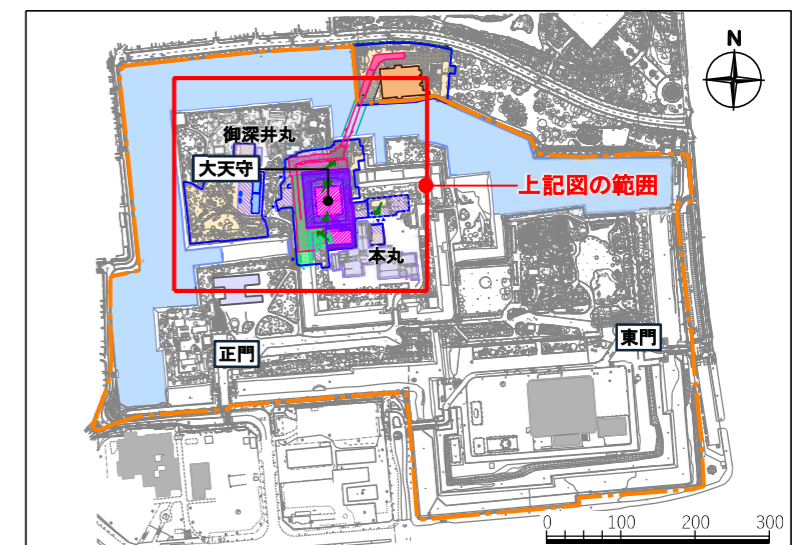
現天守閣解体工事時の平面図(敷地全体)
